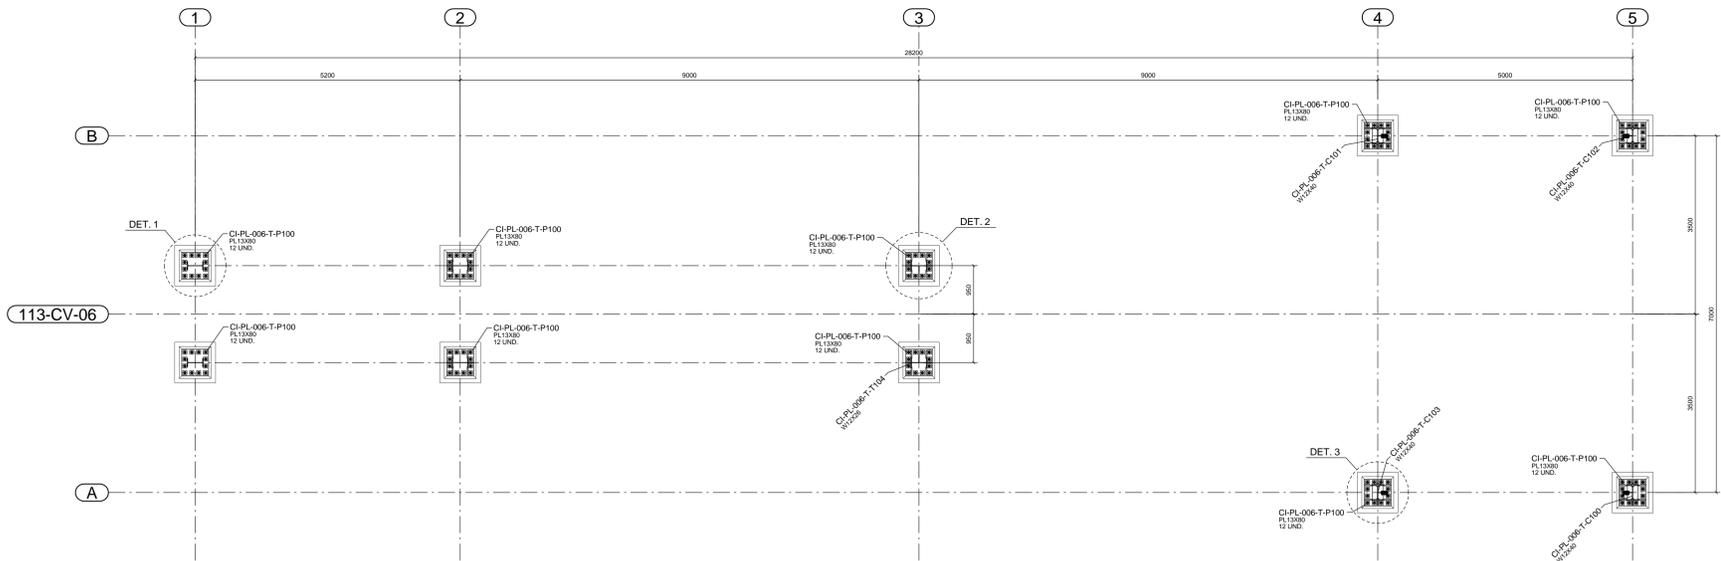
PLANO 2 - ESTRUCTURA METÁLICA DE LA FAJA TRANSPORTADORA
